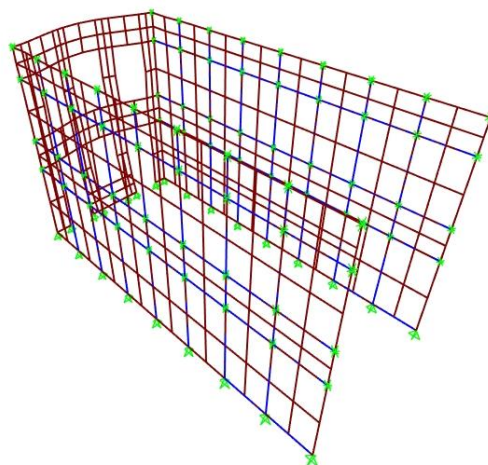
Fachada com paredes transversais modelada com elementos finitos
